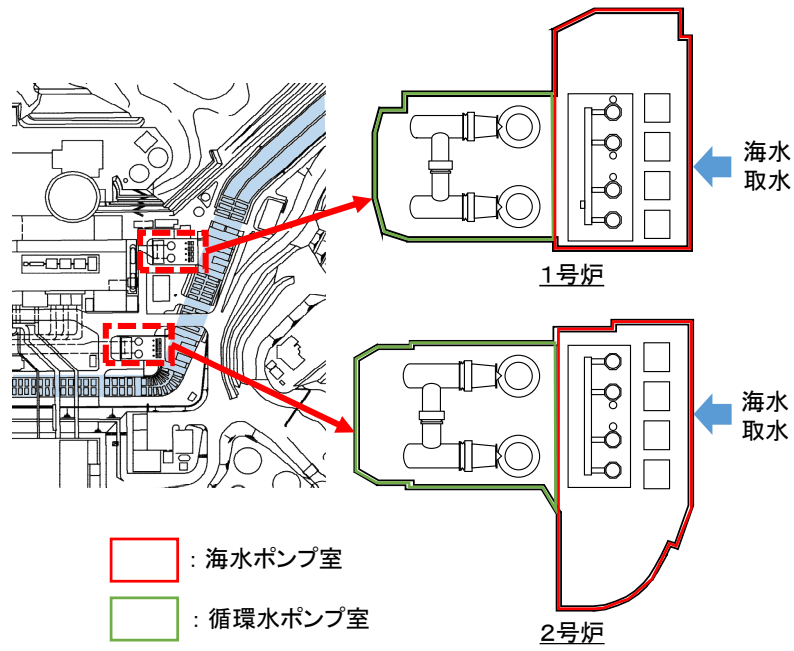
1号及び2号炉海水取水設備（平面図）
